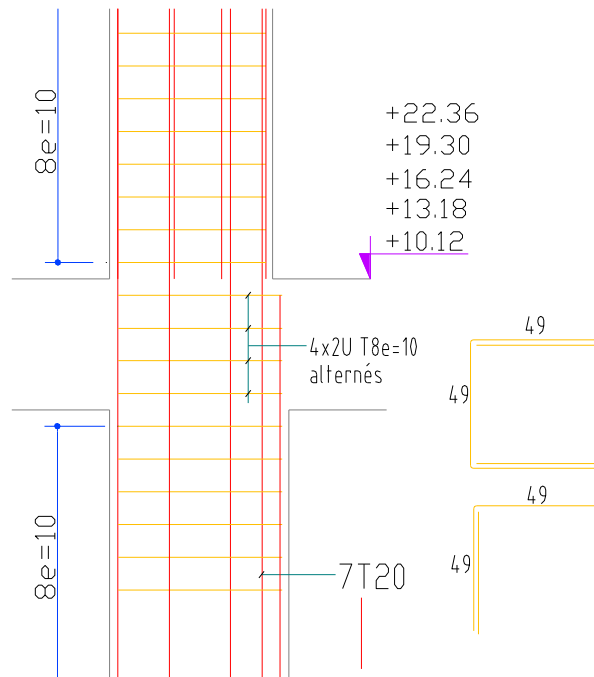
Ferrailage de recouvrement des poteaux 55 × 55 cm² avec les poteaux 50 × 50 cm².
